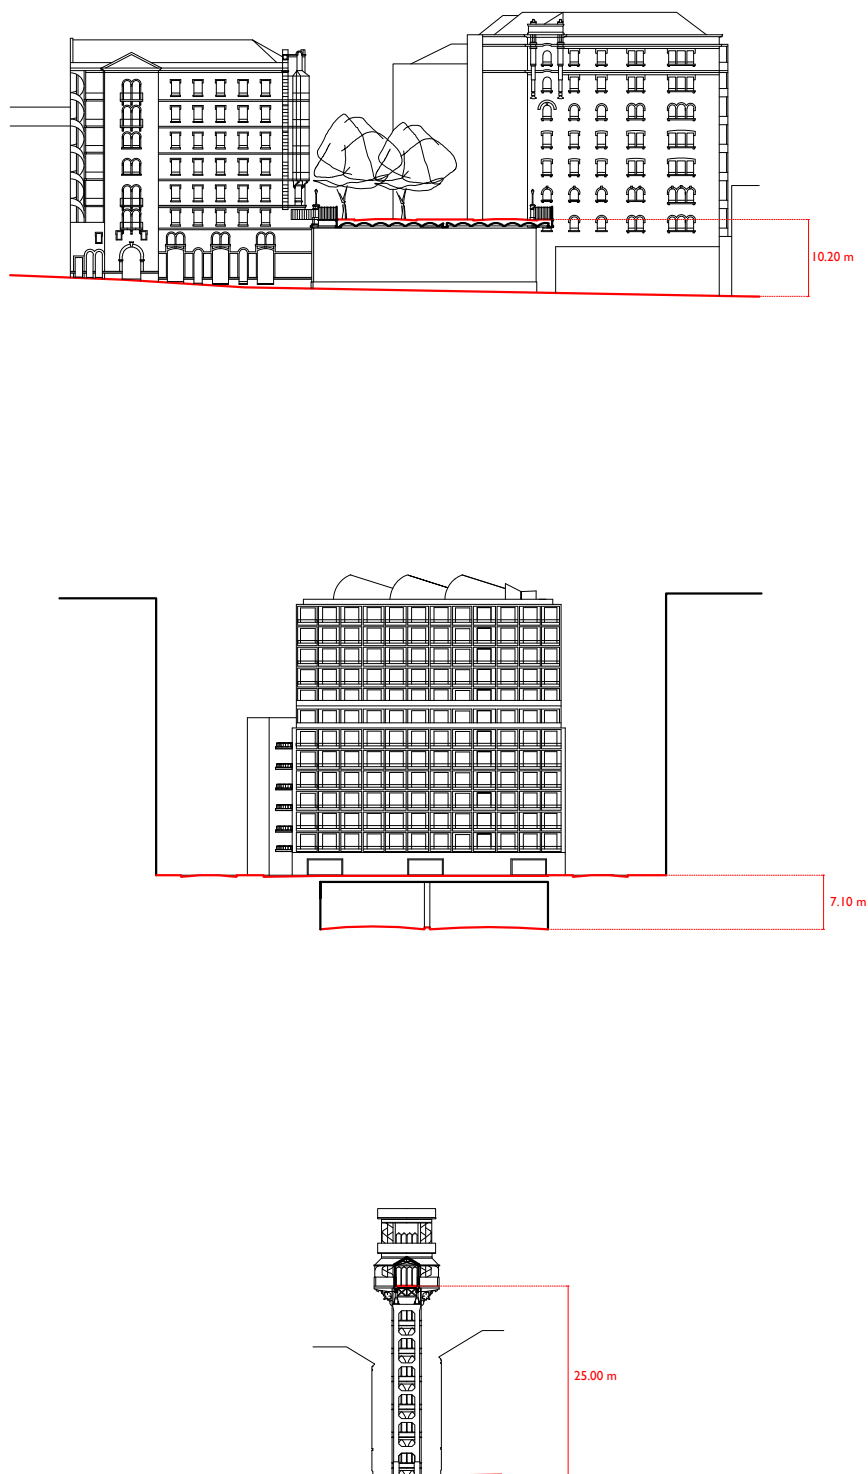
• Secção transversal da rua com múltiplos planos horizontais. Secções transversais (1:1.000).
